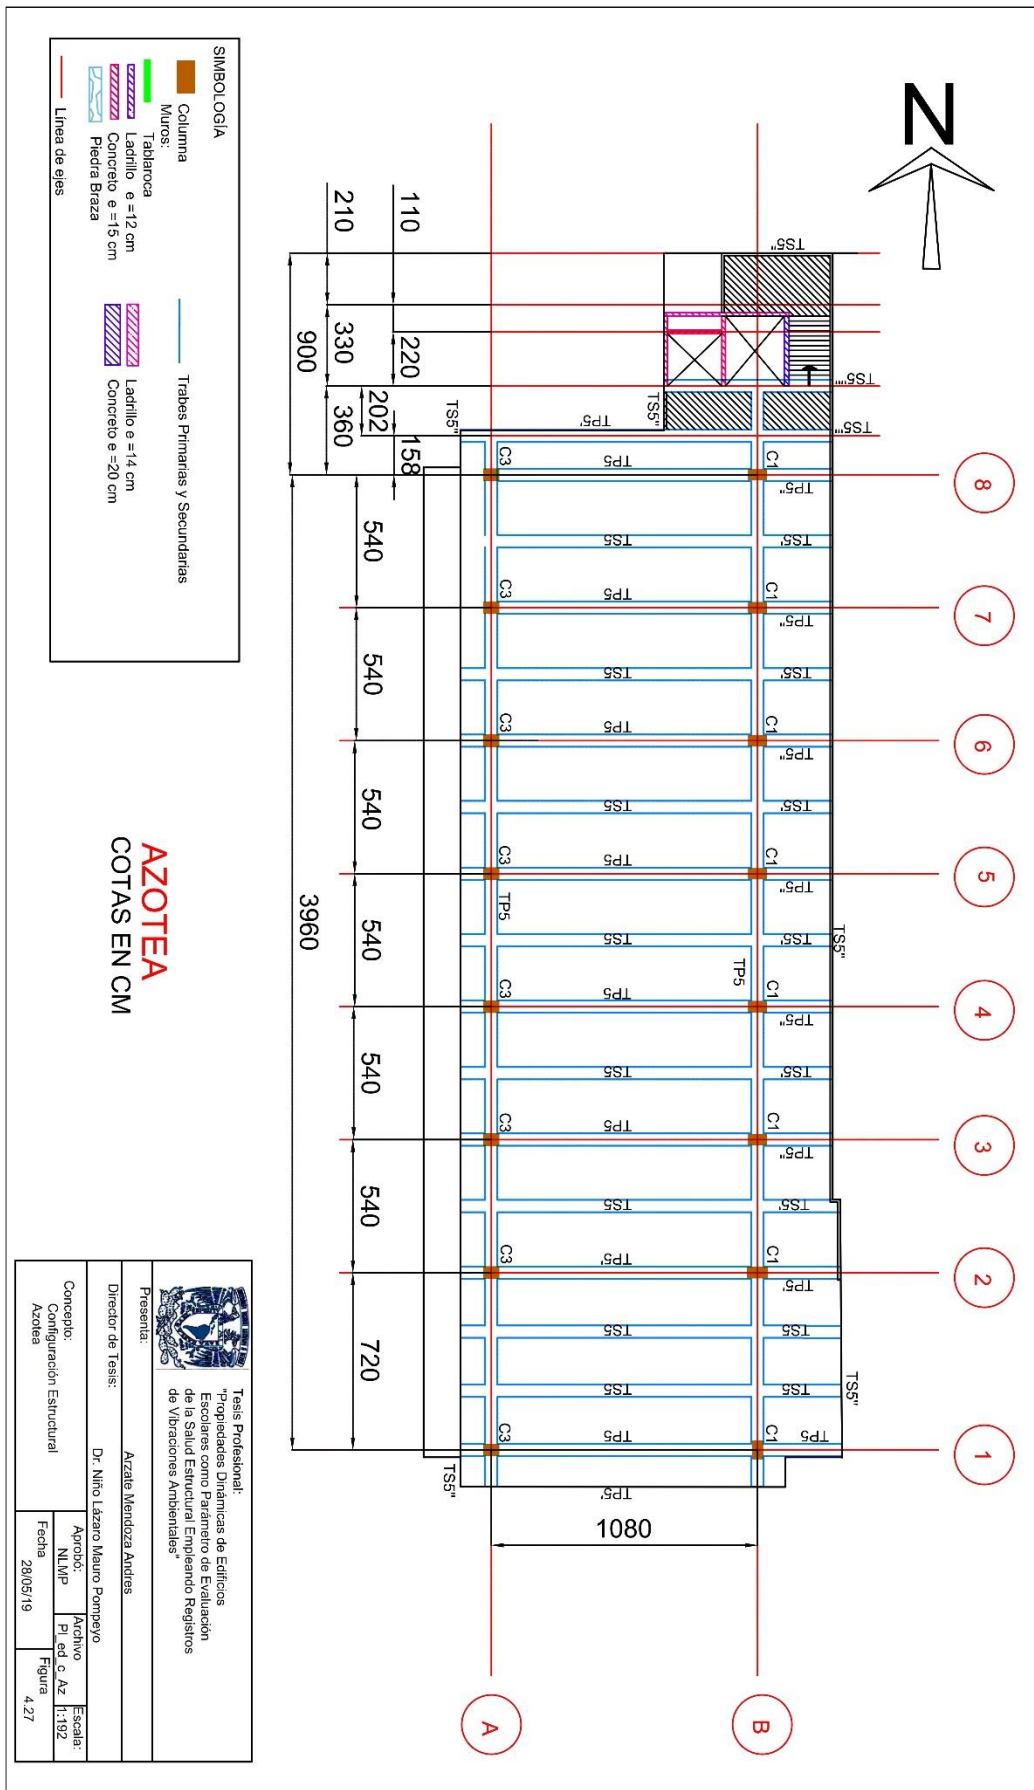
Planta estructural azotea edificio C FI, UNAM
